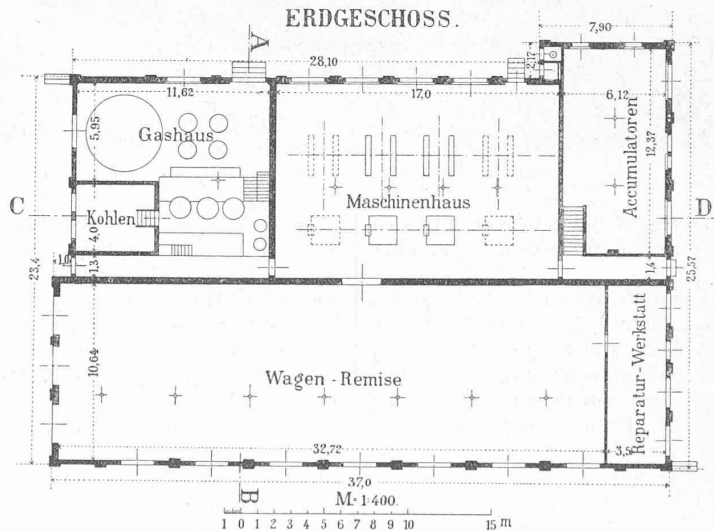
Grundriss vom Erdgeschoss.
